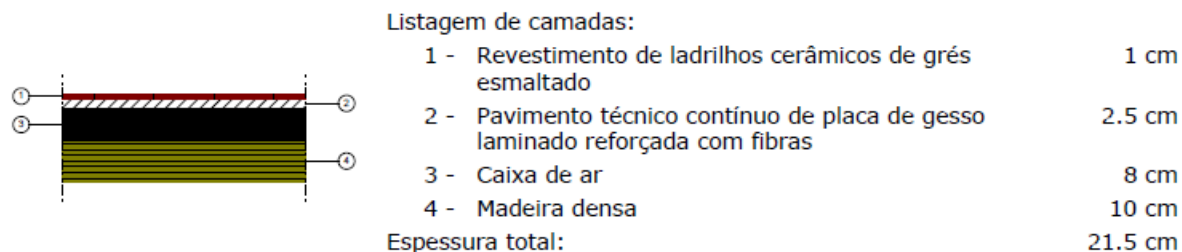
Constituição esquemática da laje mezanine (CYPE™ 2017)
